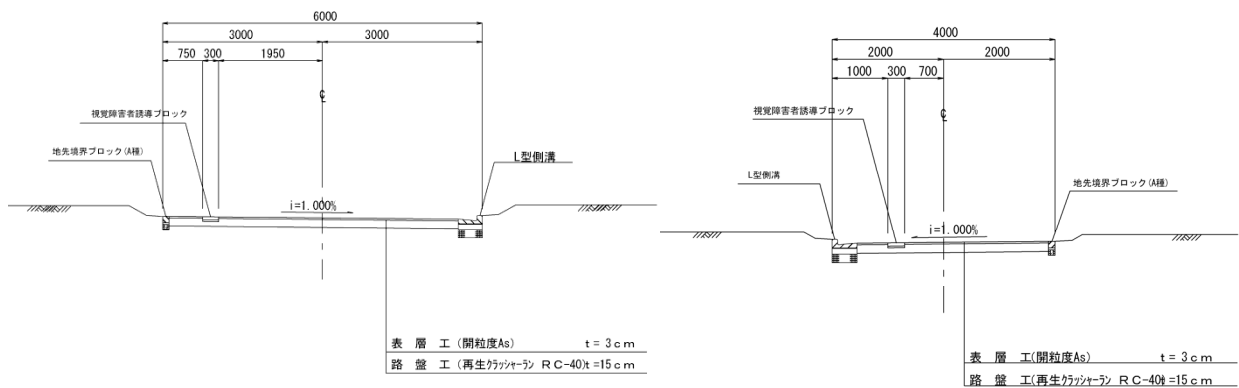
(7) 道路断面図(歩行者専用道路標準断面)
